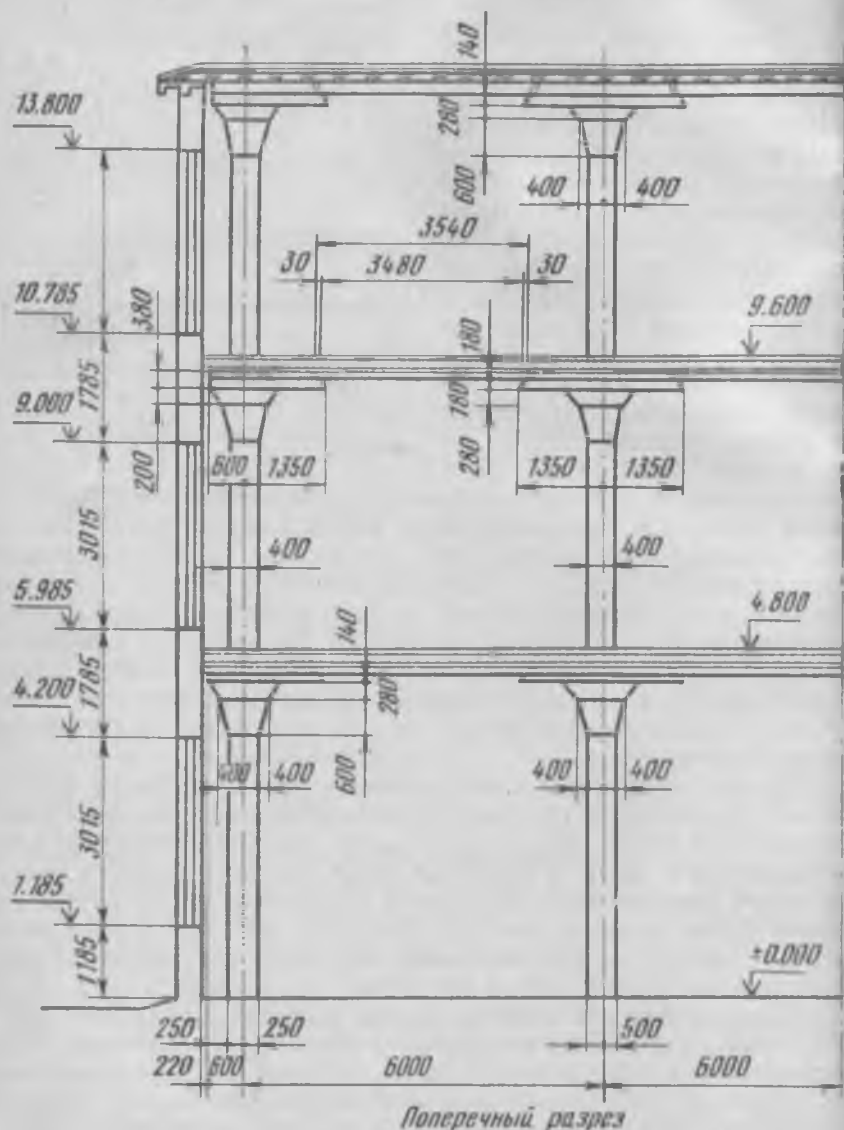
Безбалочные междуэтажные перекрытия и покрытие
